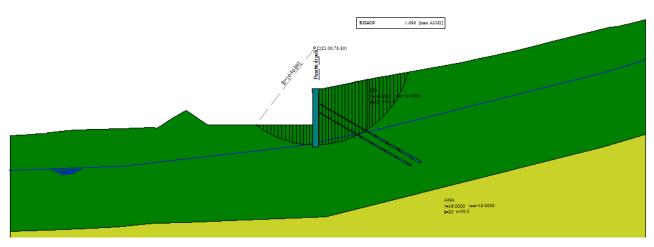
Verifica di stabilità globale - condizione statica drenata
